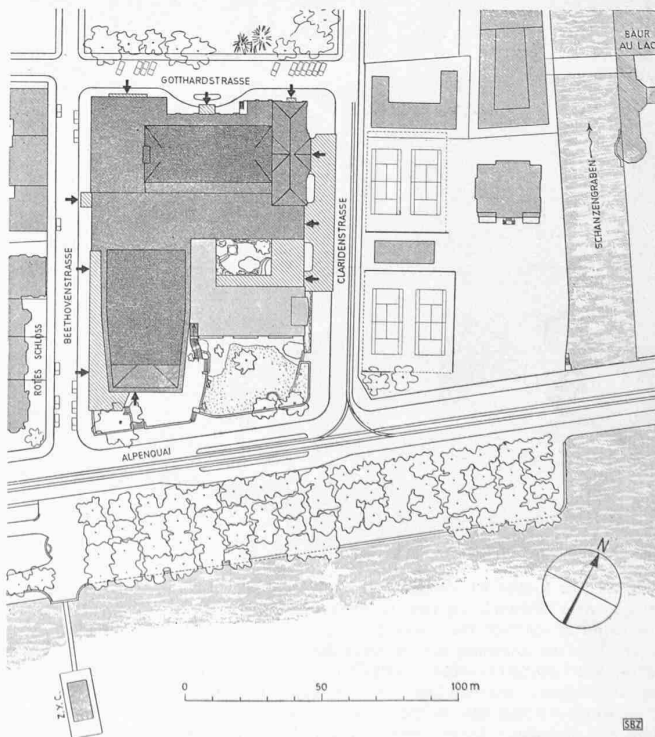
Lageplan von Tonhalle und Kongresshaus, Zürich. — 1:2500
